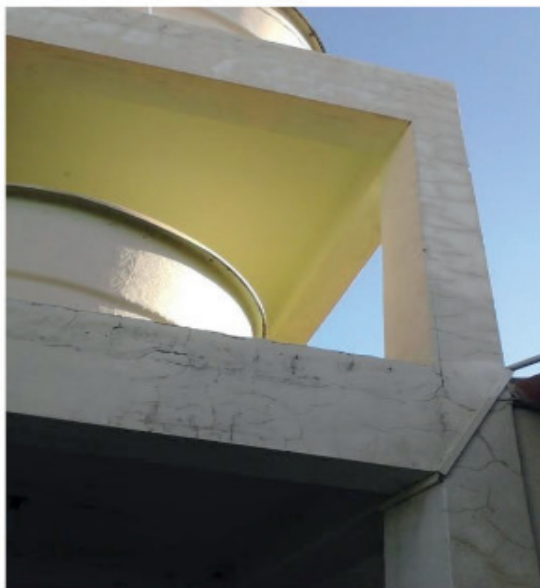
Fissuras no revestimento dos pilares e vigas da caixa d'água.
